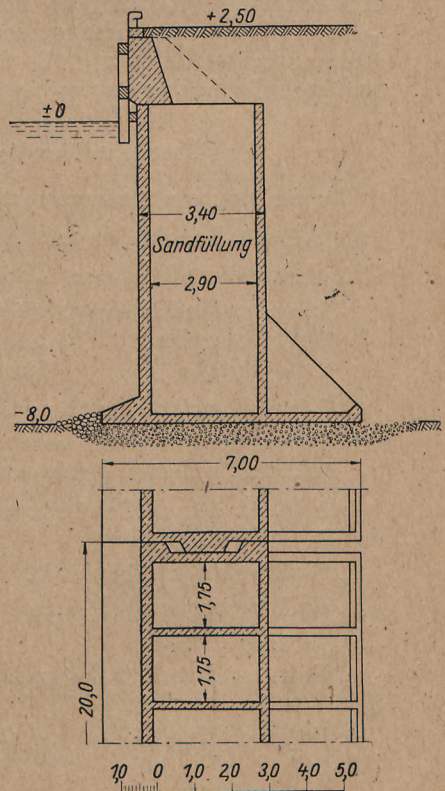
Kaimauer auf Stahlbetonschwimmkasten
